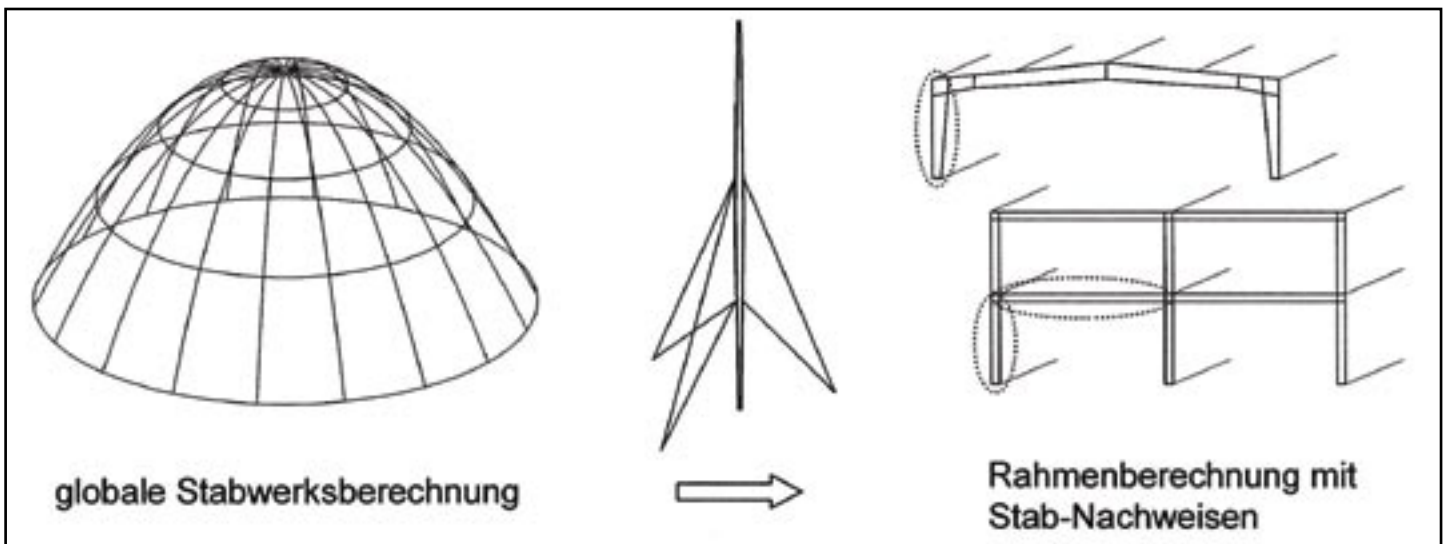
Stahlbauliche Systeme und Berechnungsverfahren
